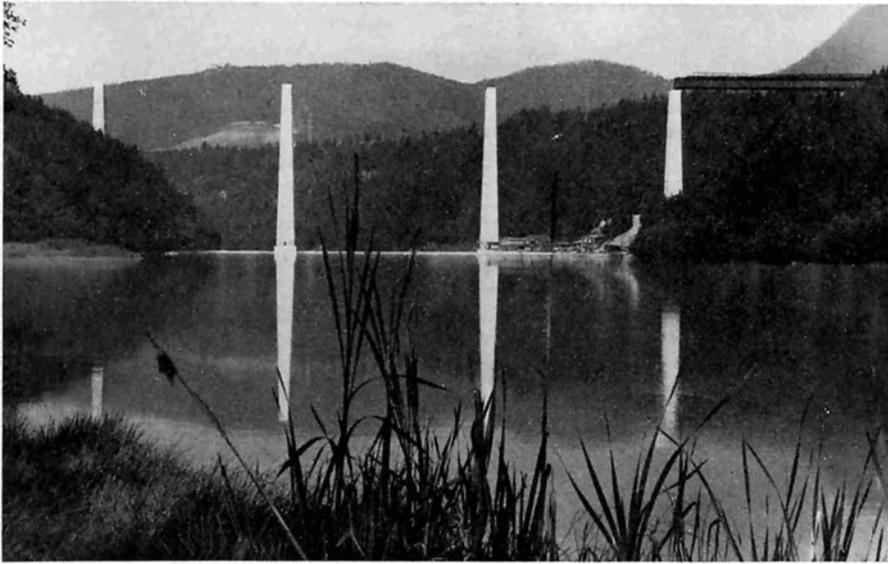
Jauntalbahn-Draubrücke, Gesamtansicht während des Tragwerk-Vorschubes
